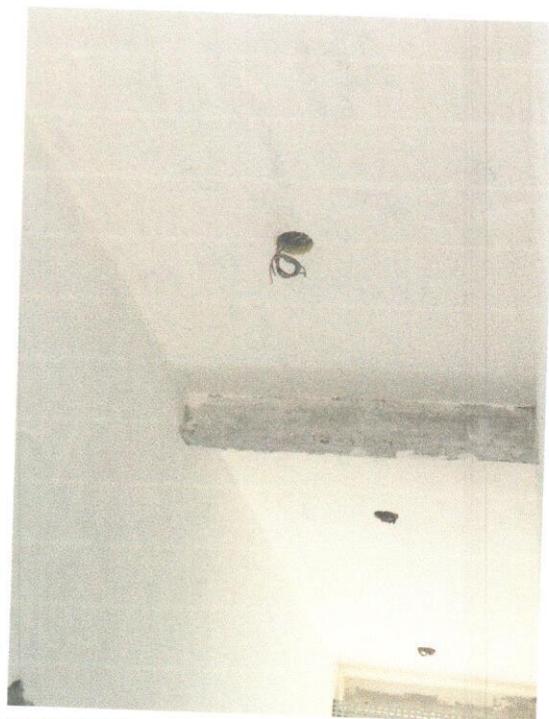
Teto interno aparelhado e já com a primeira demão de tinta.
